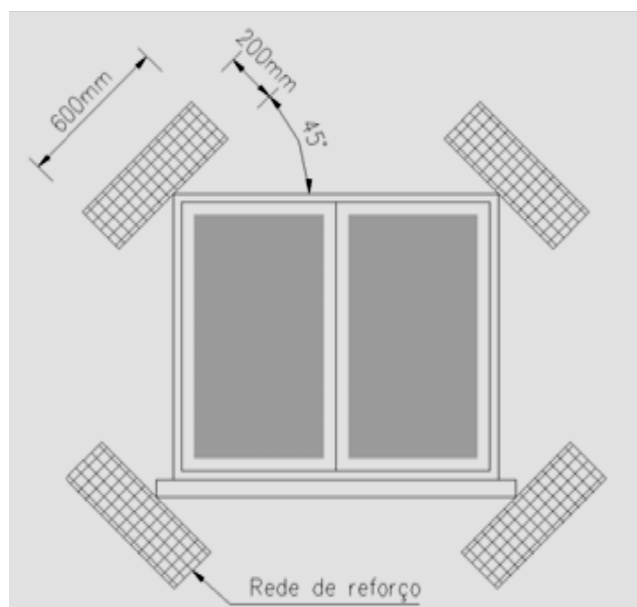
Reforços de armadura nos cantos de um vão com faixas de armadura normal coladas diretamente sobre o isolante [33]
